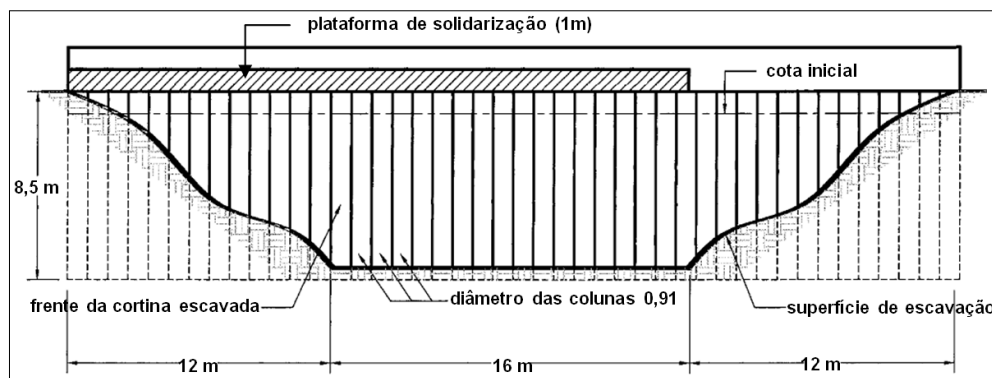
Vista da frente da VERT Wall (adaptado de Briaud *et al*, 2000)
